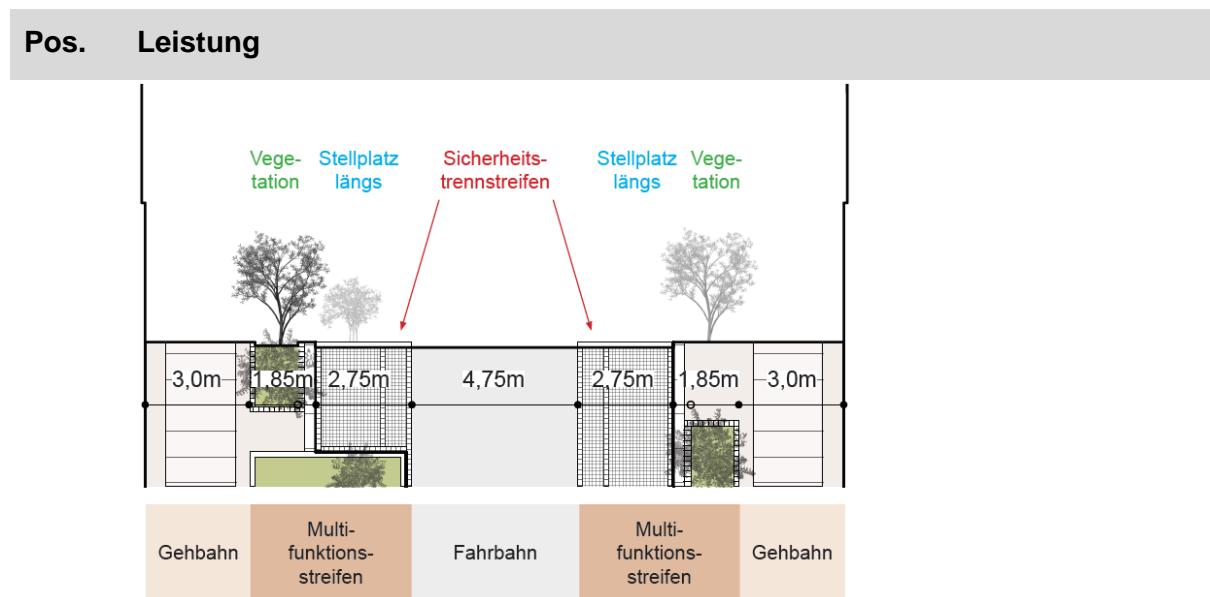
Fahrradstraße Kochstraße – Abschnitte ohne Baumbestand, Prinzipschnitt mit Draufsicht
